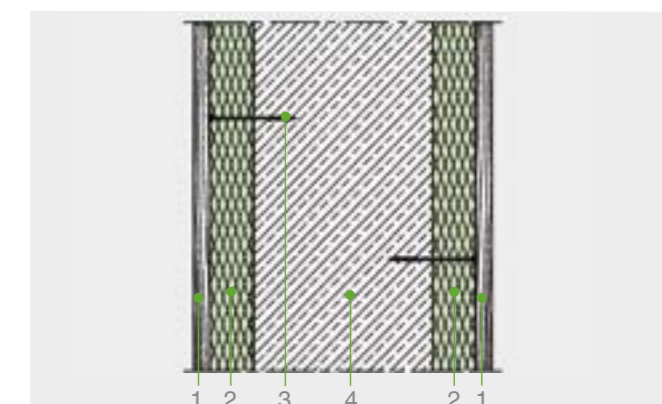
Installazione nella cassaforma e fissaggio con chiodi delle lastre di Styrodur® 3035 CS.
